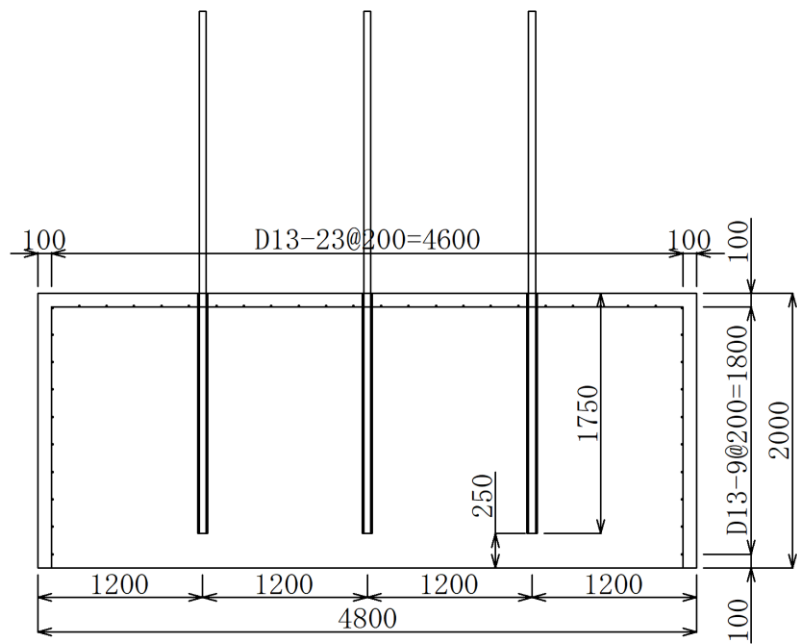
(2) 実験体①の配筋図 (A-A 断面図)
